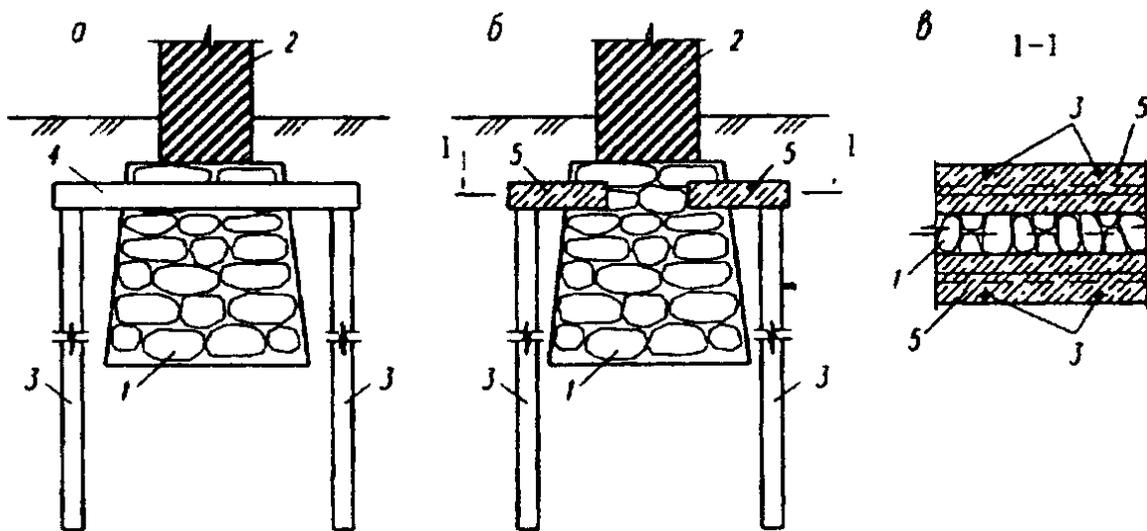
Варианты конструктивных решений «пересадки» усиливаемых фундаментов на вертикальные сваи: а - с поперечными распределительными балками; б - с продольными; в - сечение по I - I; 1 - усиливаемый фундамент; 2 - стена; 3 - сваи; 4 - балка поперечная; 5 - балка продольная, заделанная в штрабе
